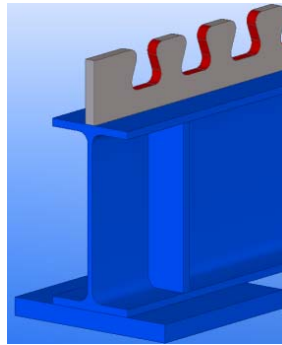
Desenho das nervuras e das chapas metálicas colocadas sob o apoio
